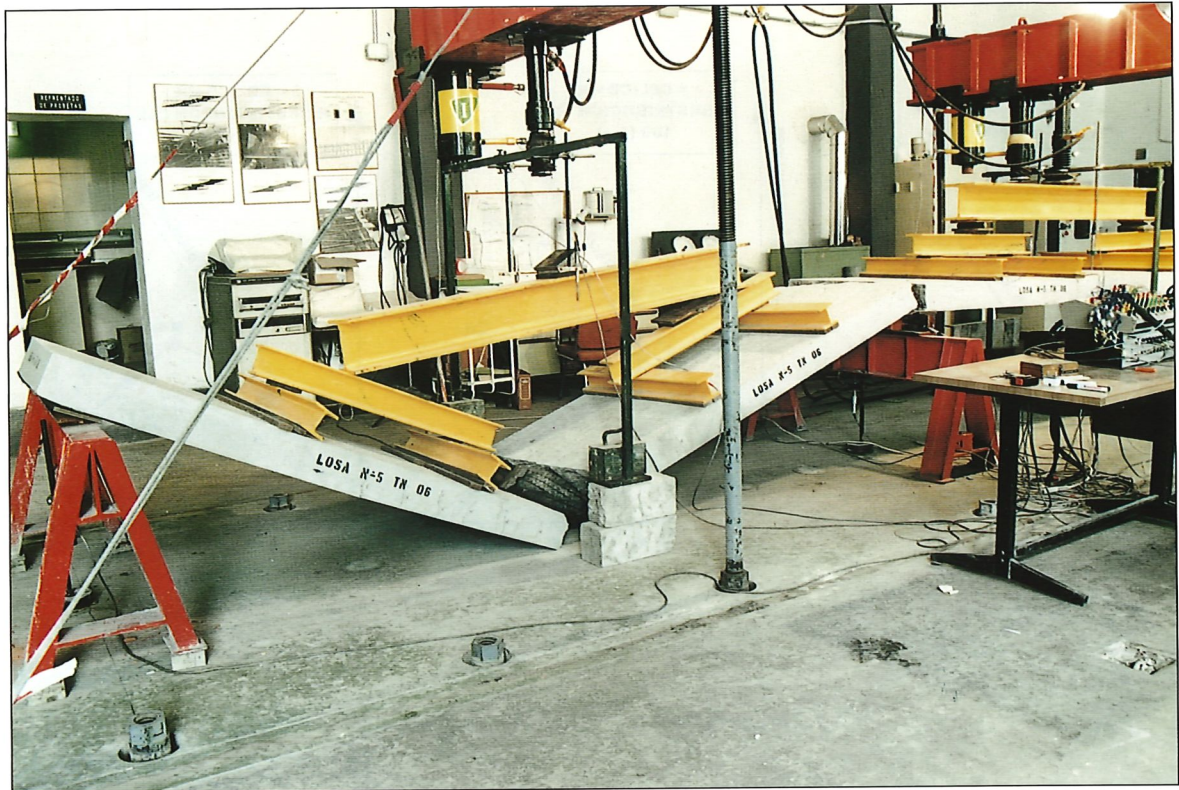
Colapso losa 5 (armada con acero de baja ductilidad).
